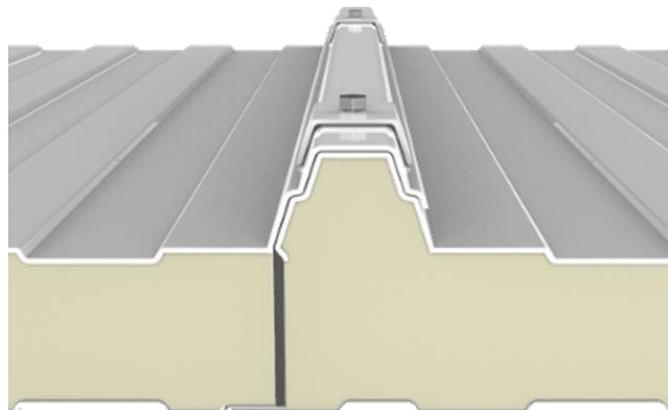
Detalle de la unión entre los paneles de cubierta (Grupo Panel Sándwich. Recuperado de: <https://www.panelsandwich.com/producto/panel-sandwich-tapajuntas/>)
